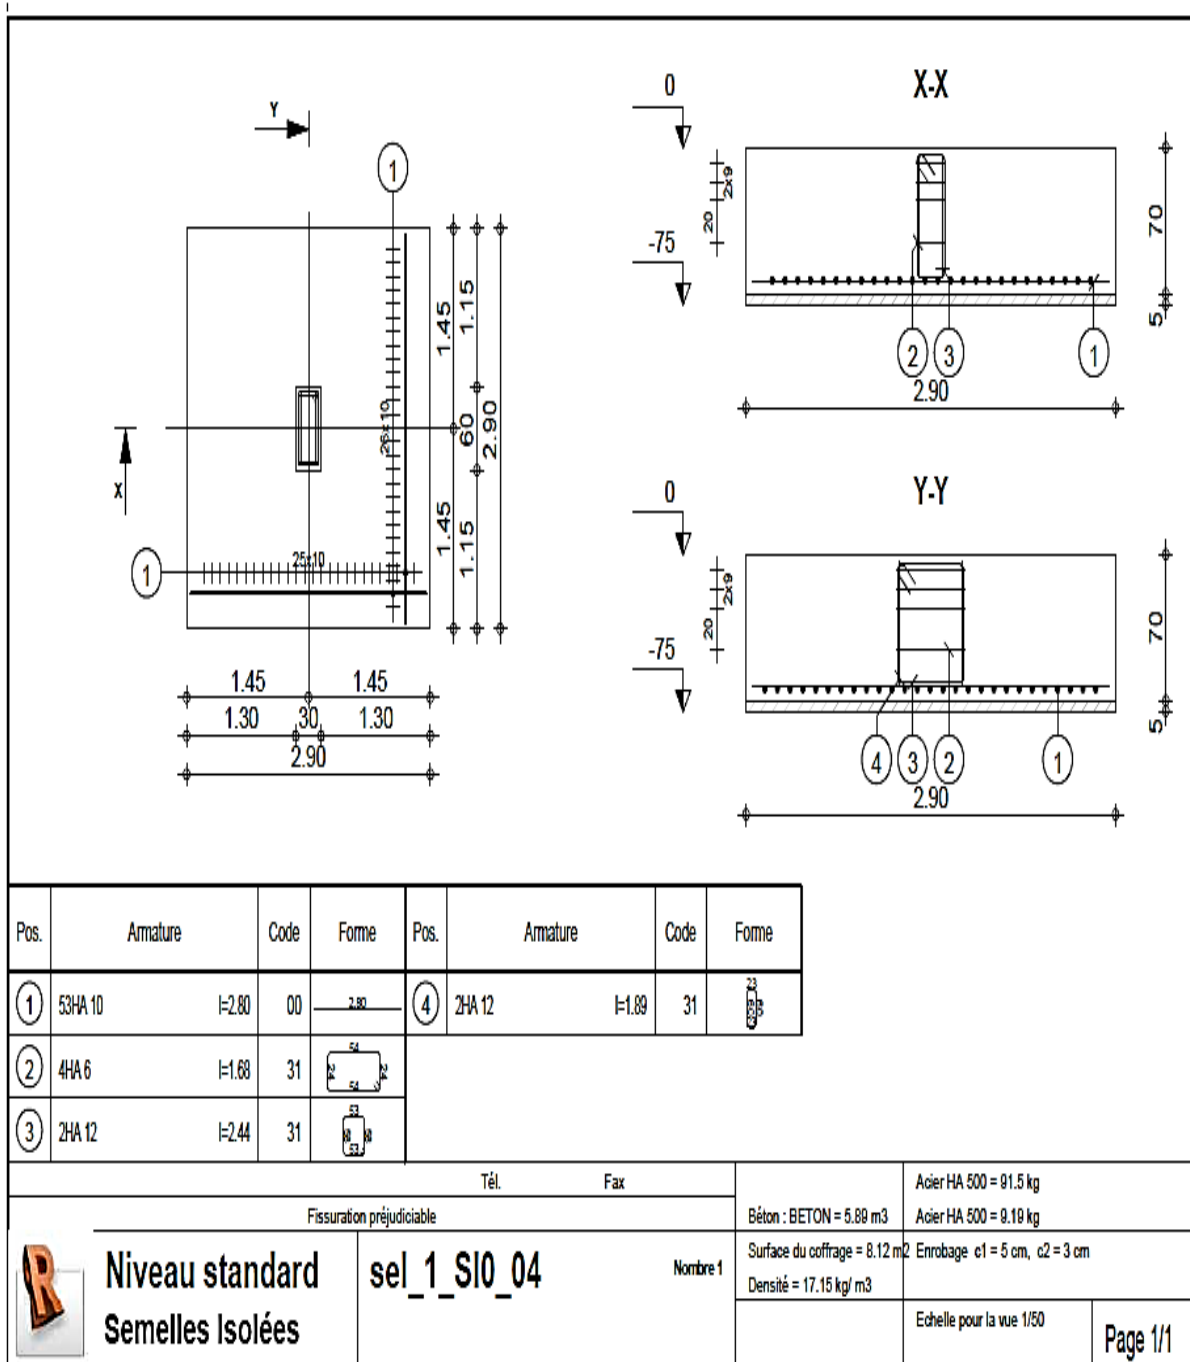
Plan d'exécution de la semelle isolée S10_04 , Bloc 1, Tranche 1.
